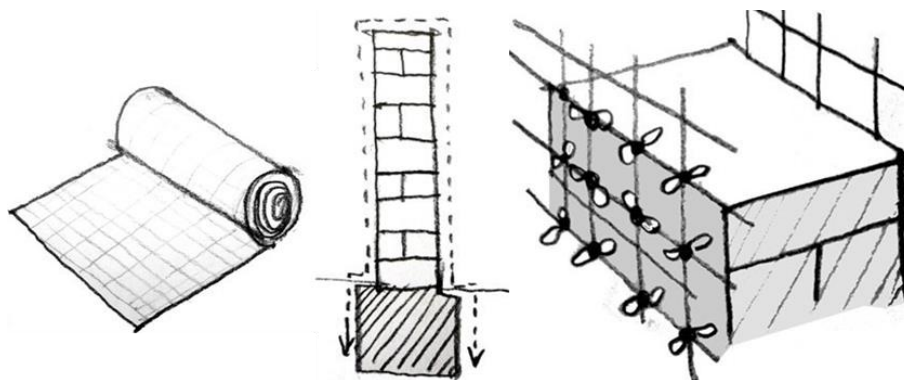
Mejora del muro de adobe con geomalla. Fuente: 123cua Arquitectos - archdaily
